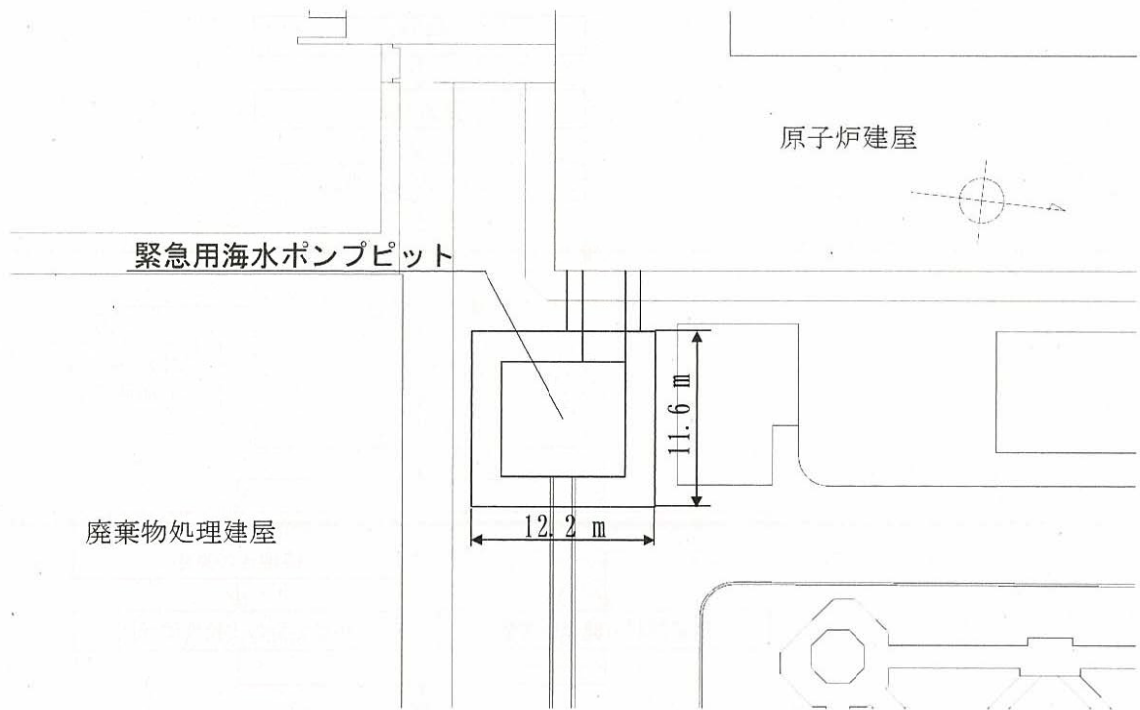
(2) 緊急用海水ポンプピット位置図
